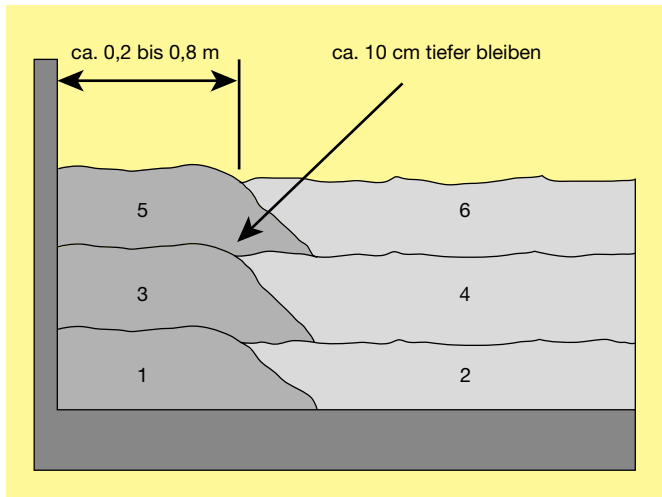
Beispiel für eine Einbaukonzeption bei zonierter Bauweise nach [17], links der Randbeton mit den hohen Anforderungen aus der Expositionsklasse und Feuchteklasse, rechts der temperaturoptimierte Kernbeton
